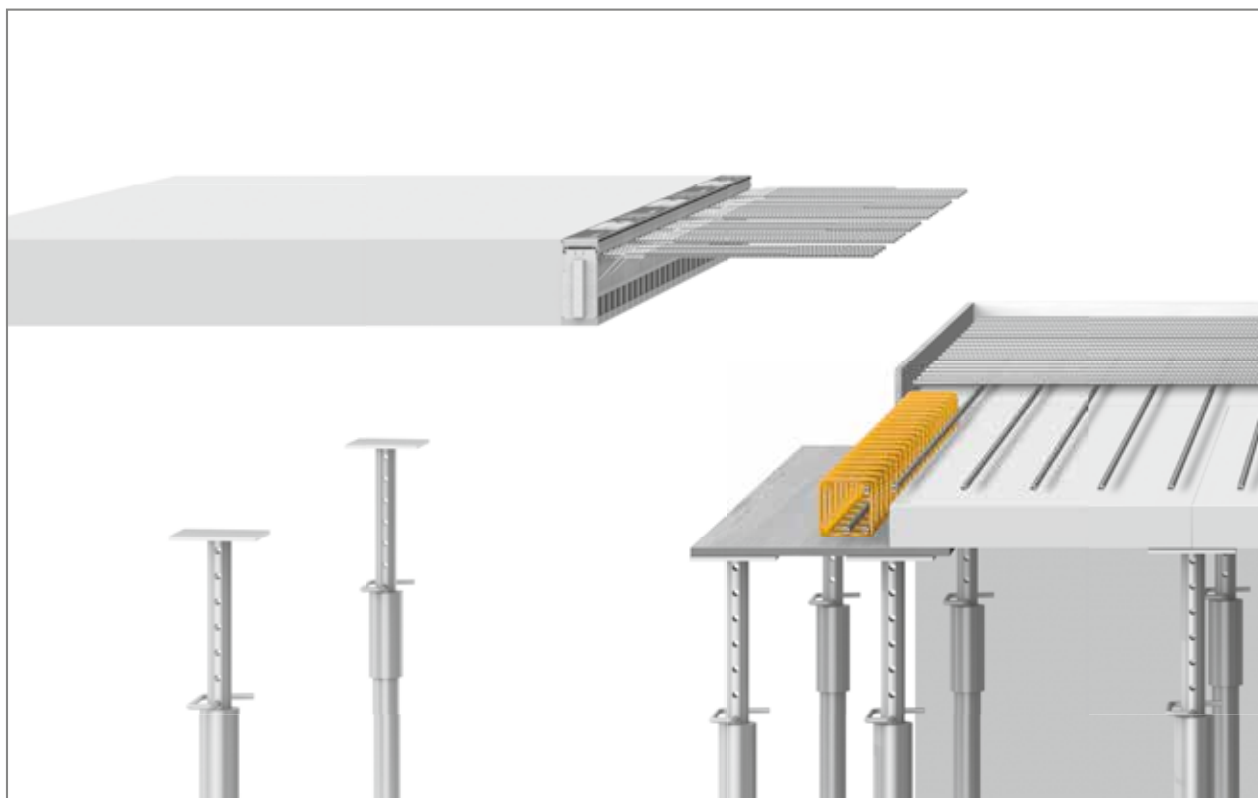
Schöck Isokorb® T tipo KL: preparazione del cassero e dell'armatura per il montaggio del pannello prefabbricato con T tipo KL integrato
